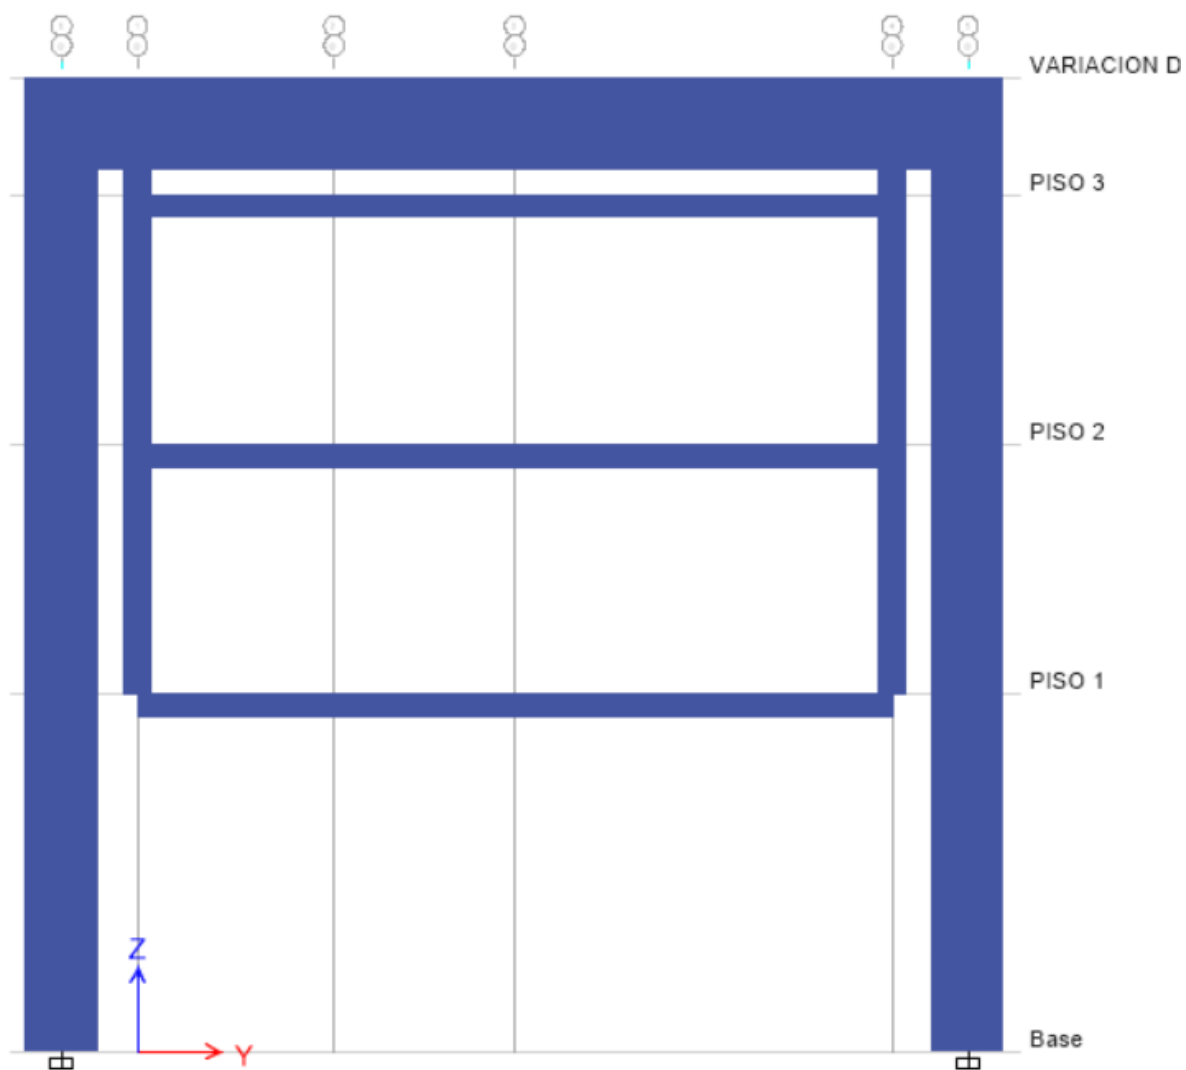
vista de perfil (internos) del modelo estructural con sistema semi-colgante.
